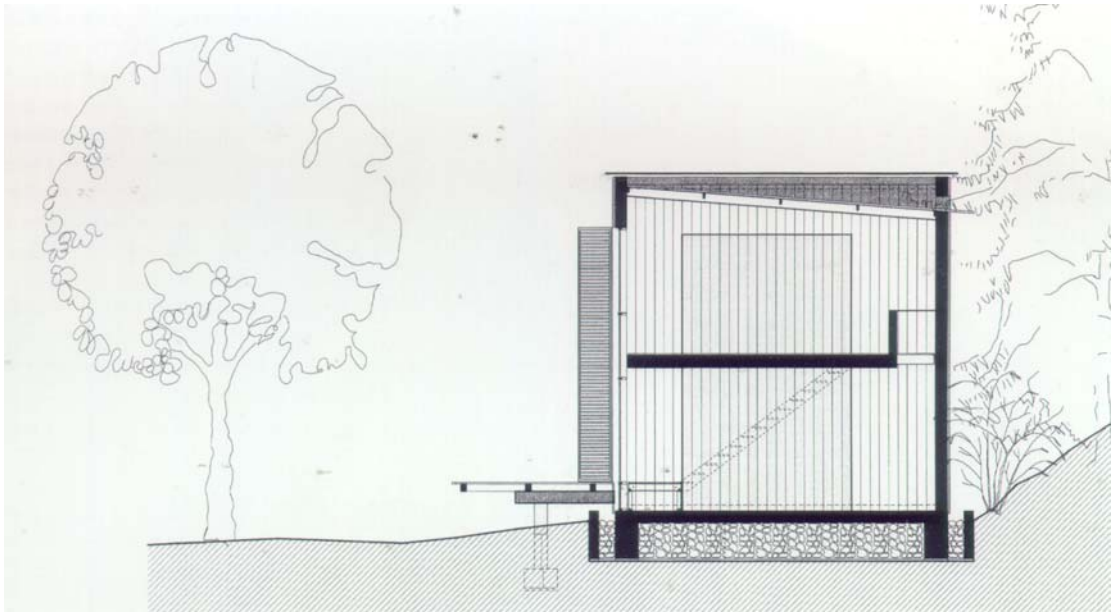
House and Office* –corte. Fonte: Stungo (1998)
